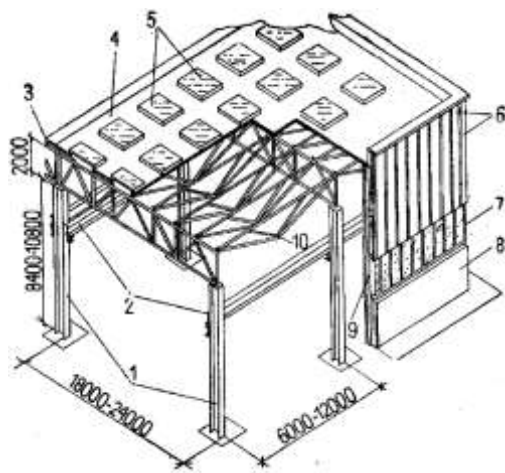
Будівля з кроквяними фермами з трубчатих профілів: 1 – колони; 2 – підкранові балки; 3 – кроквяні ферми; 4 – покриття з сталевих листів; 5 – зенітні ліхтарі; 6 – панель з металевих листів з ефективним утеплювачем; 7 – вікно; 8 – цоколь (з панелей або цегли); 9 – стіновий каркас (фахверк); 10 – решітчастий ригель.
